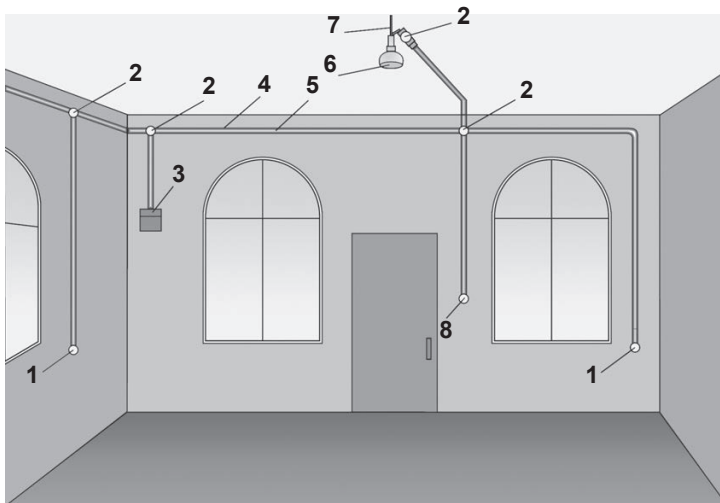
План-схема электропроводки: 1 — розетка; 2 — разветвительная коробка; 3 — электросчетчик; 4 — места крепления проводов к основанию; 5 — провод; 6 — светильник; 7 — крюк для его крепления; 8 — выключатель
